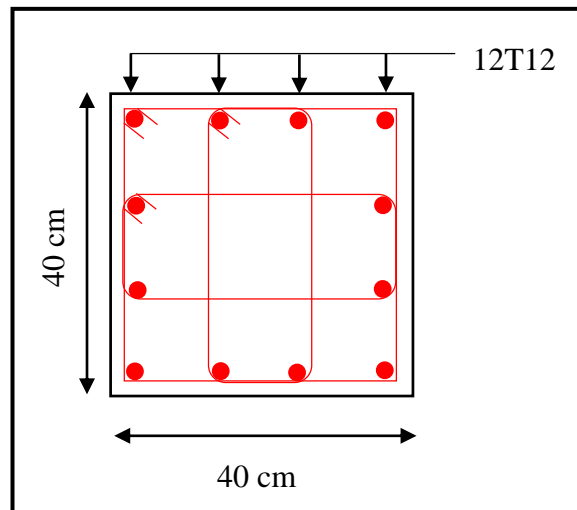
exemple schéma de ferrailage d'un poteau
